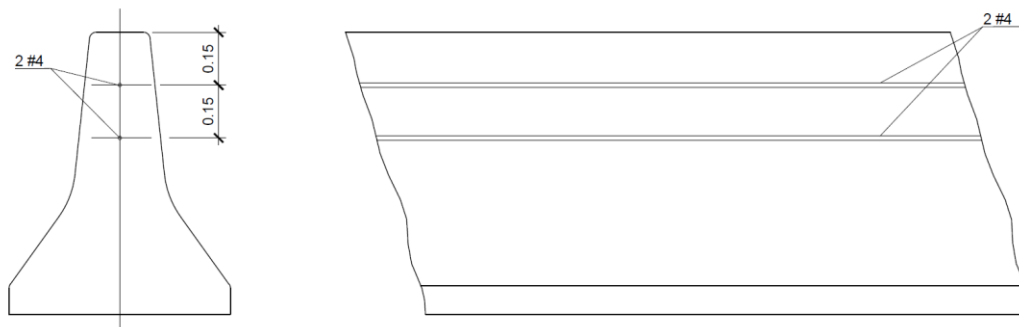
Detalle del acero de refuerzo que se indica en los planos del proyecto para la barrera vehicular medianera.
